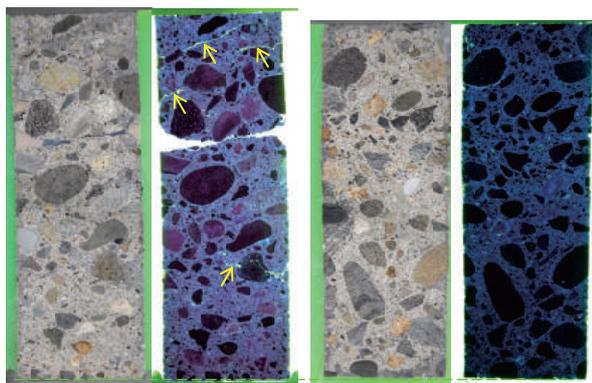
コア切断面の微細ひび割れの観察 (Ki橋)
